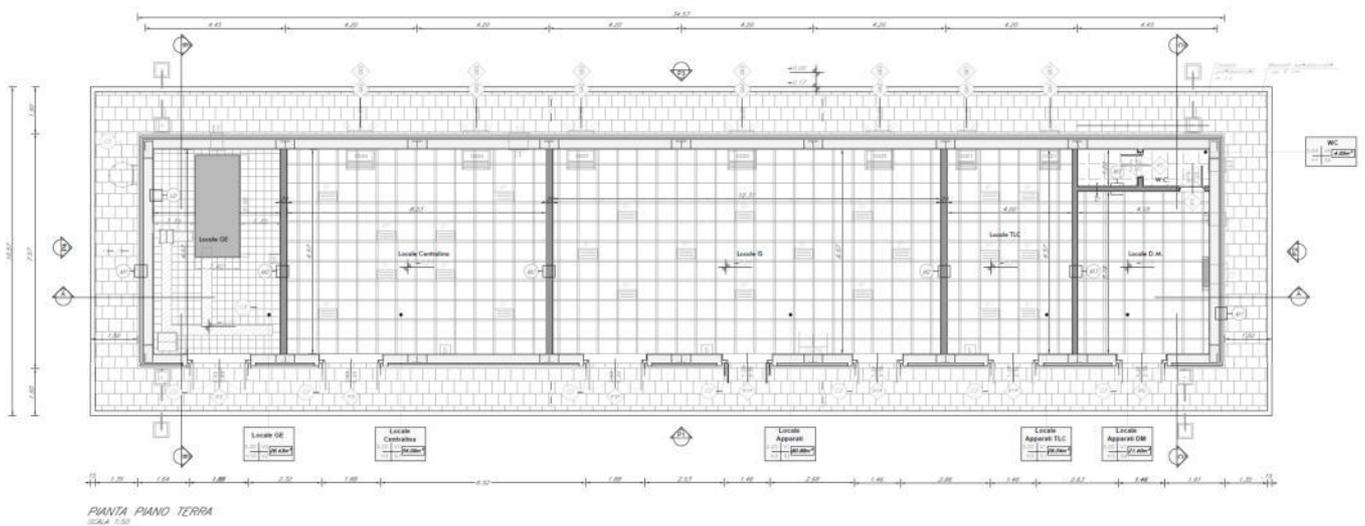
Pianta piano terra fabbricato IS-PP/ACC (FA-E)
